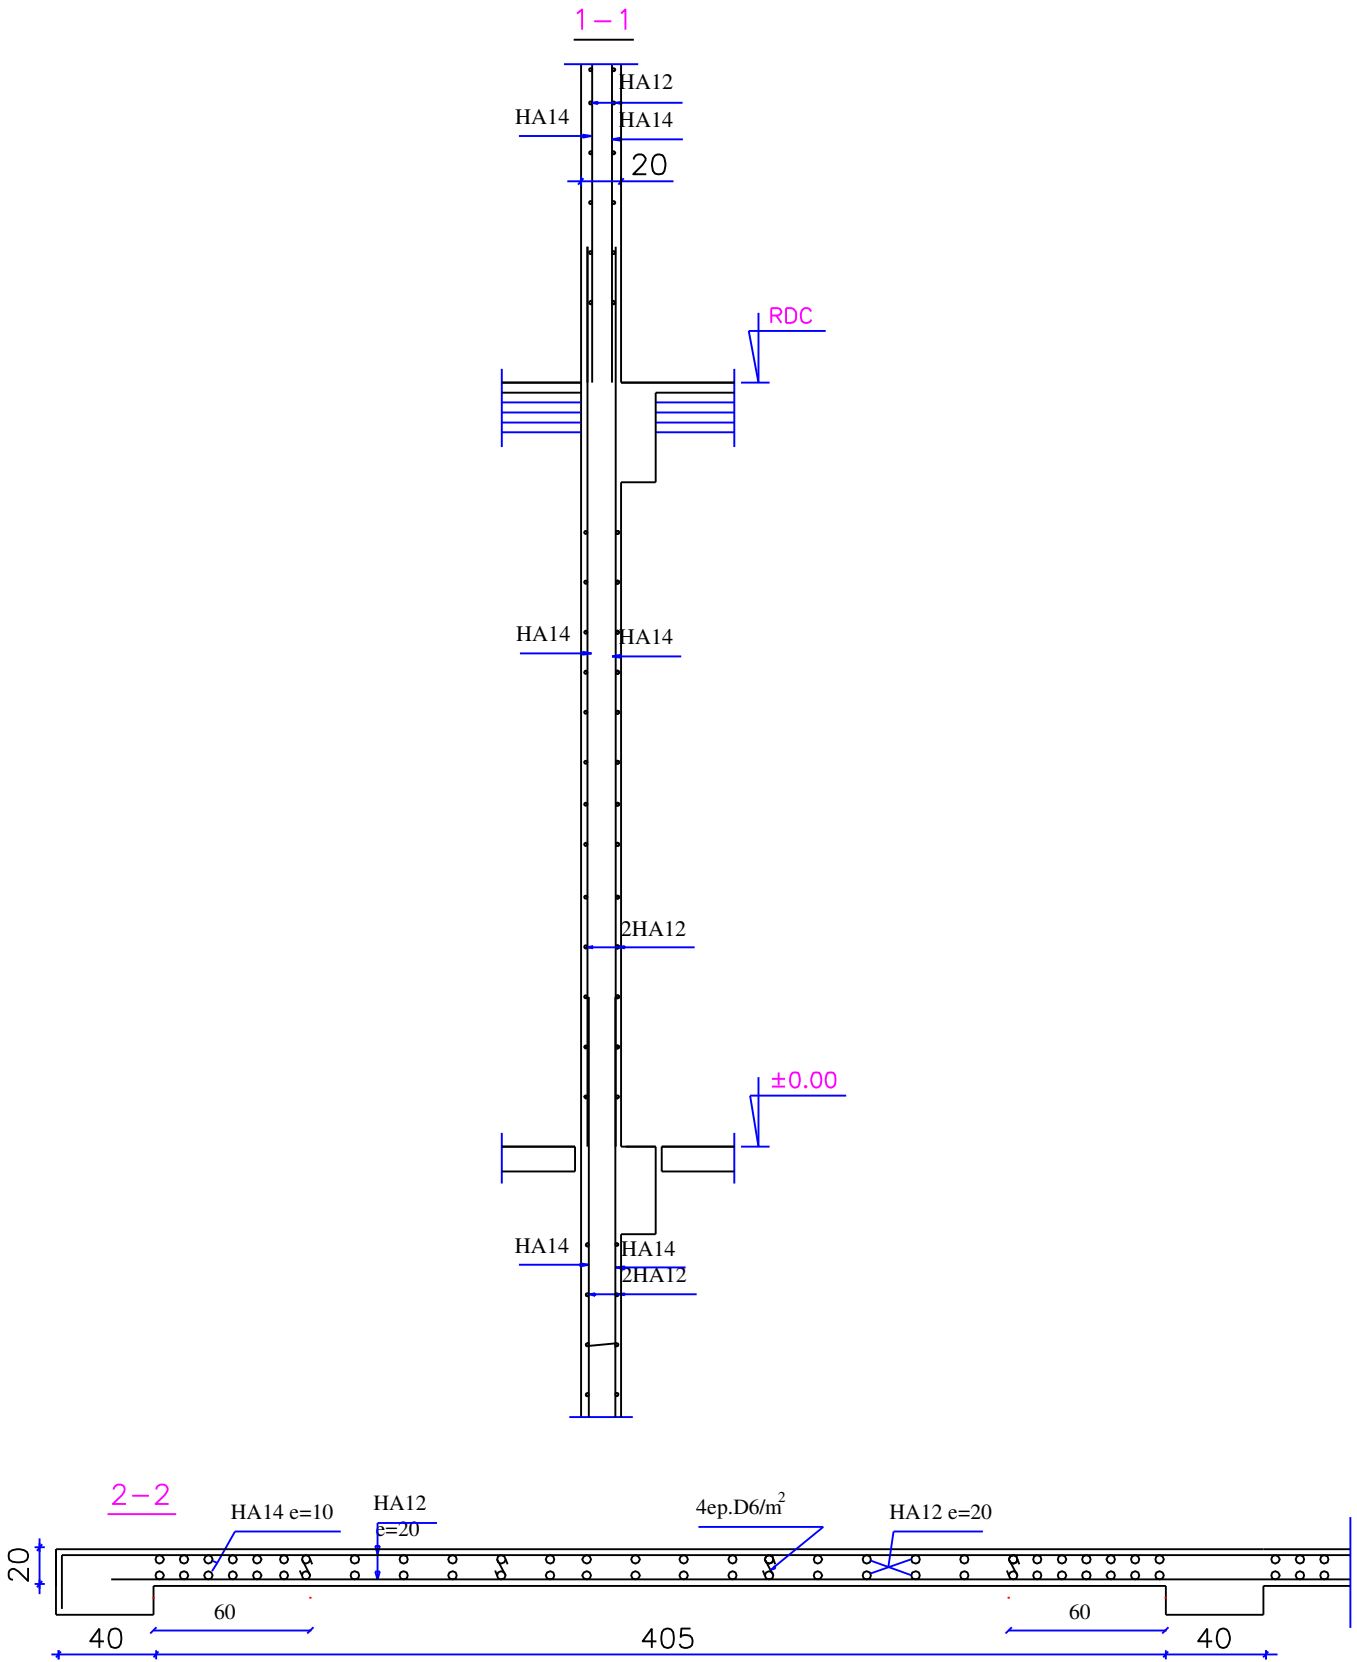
Détails d'ajout des voiles selon une coupe transversale
